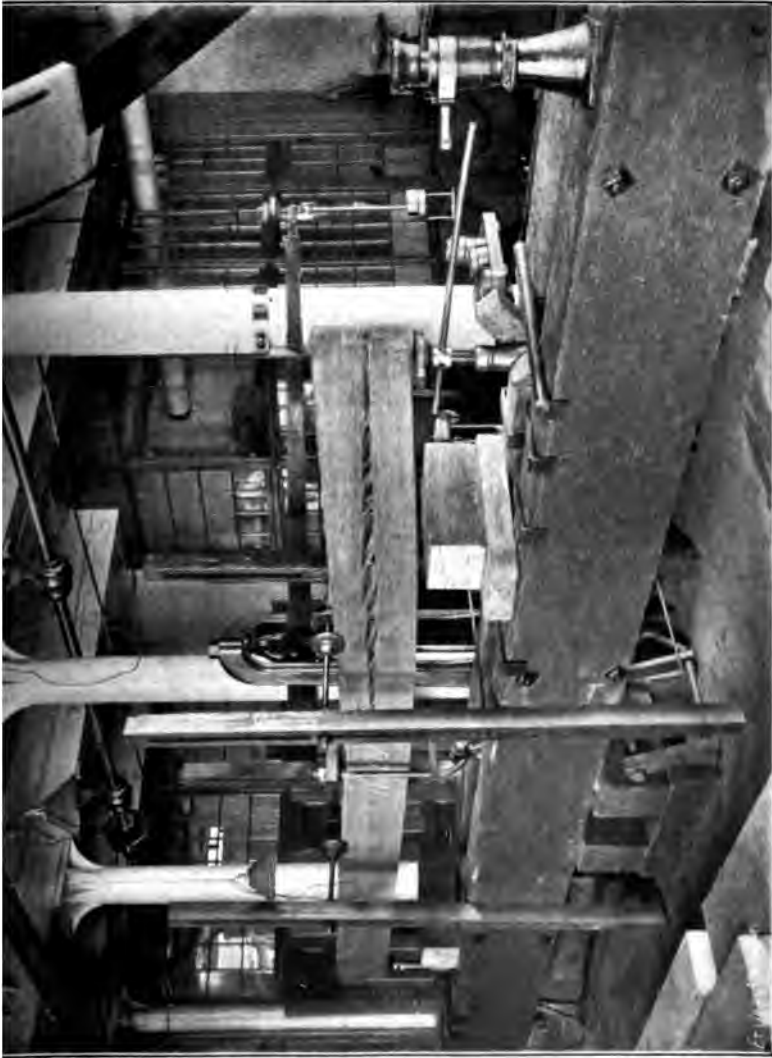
Appareil pour l'essai des poutres en bois, Boston
